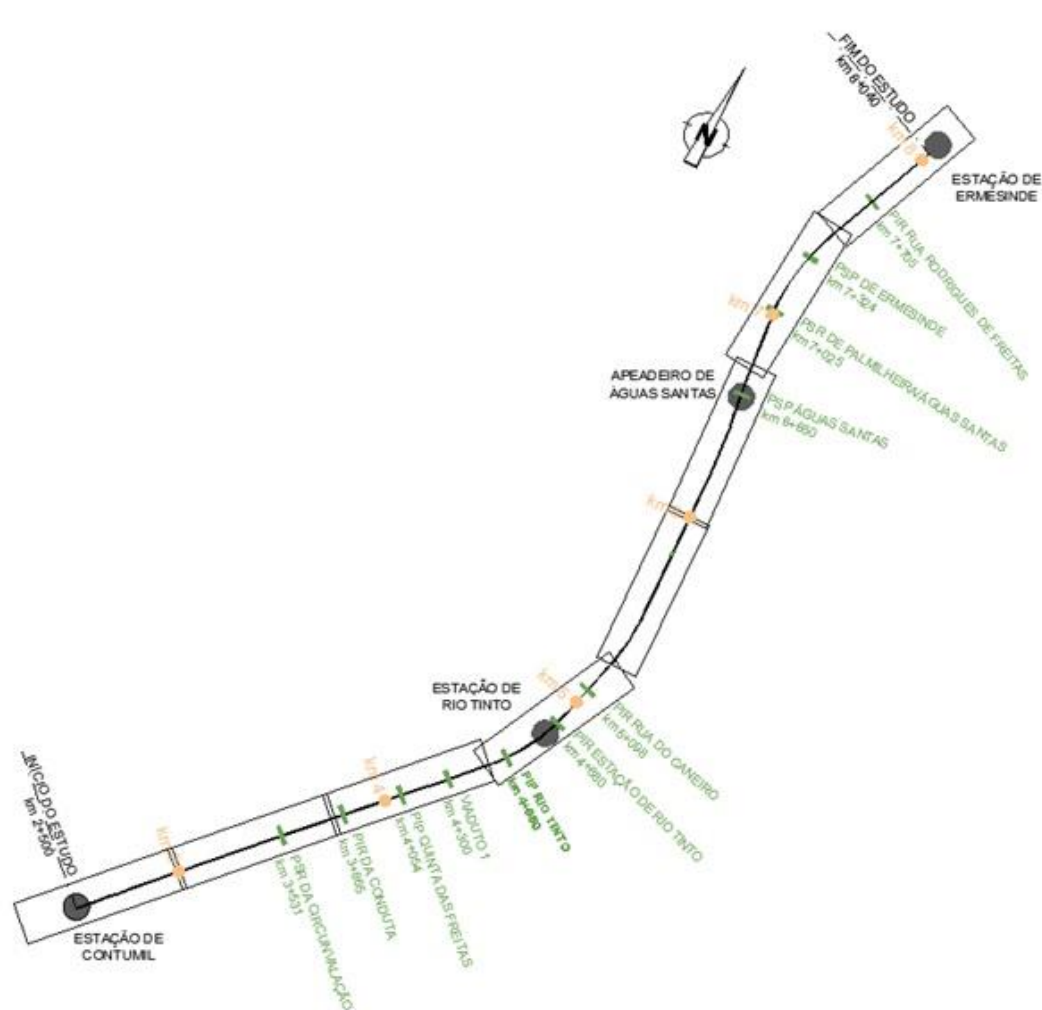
Esquema simplificado do Projeto da Quadruplicação do troço Contumil-Ermesinde
